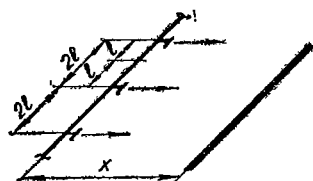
Схема установки воздухораспределителей в ряд.
